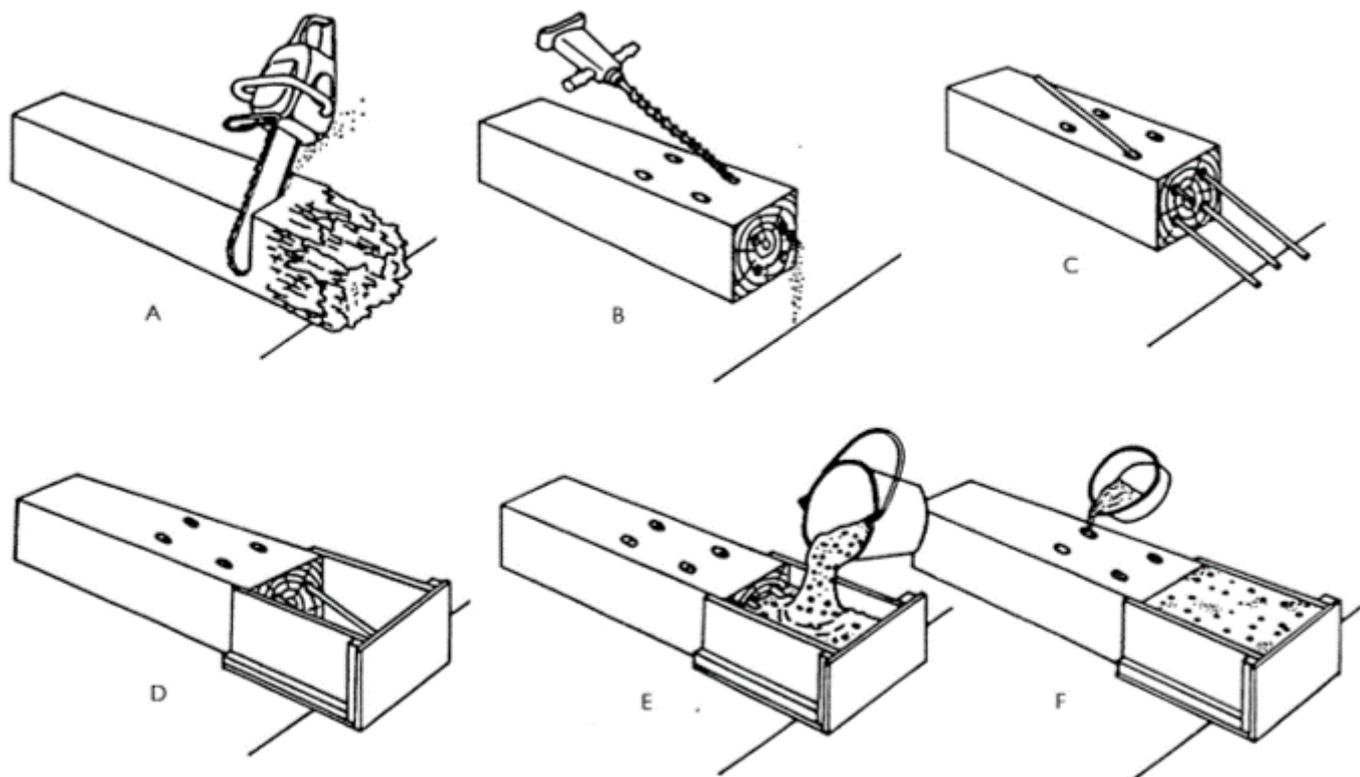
Proceso de reparación para la madera en el sistema Beta.
